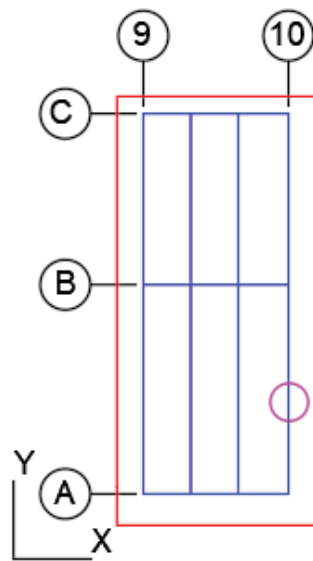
Terceiro pilar retirado localizado na seção 10, entre as regiões A e B.
